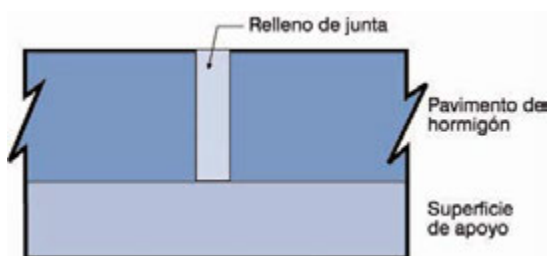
Colocación de elementos compresibles contra bordillos, muros y zapatas para consecución de la junta de dilatación.
